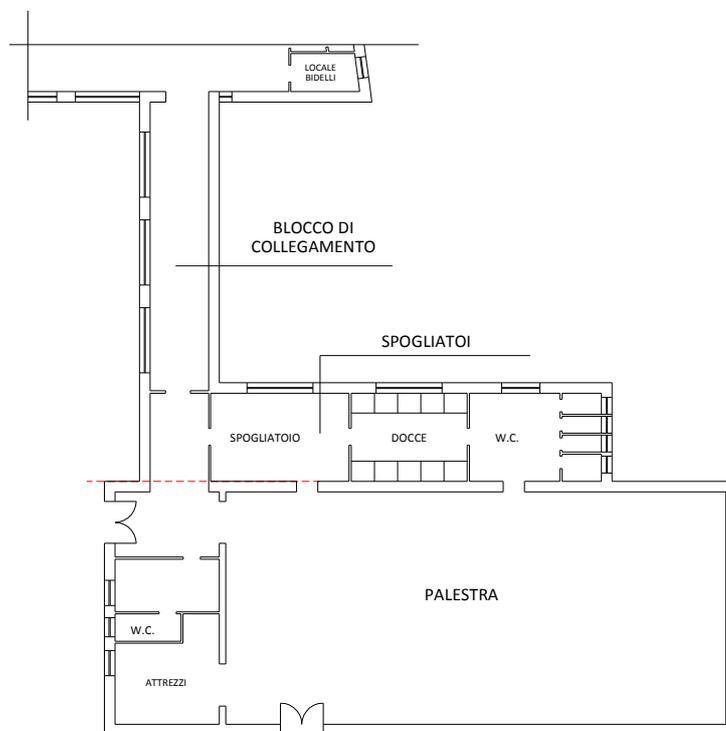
8: Pianta del blocco palestra e collegamento.
